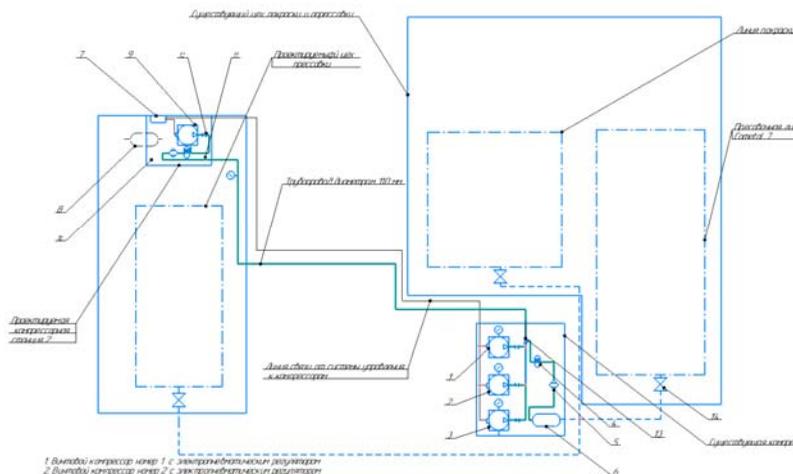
Схема расположения компрессоров в проектируемой и существующей компрессорной станциях
